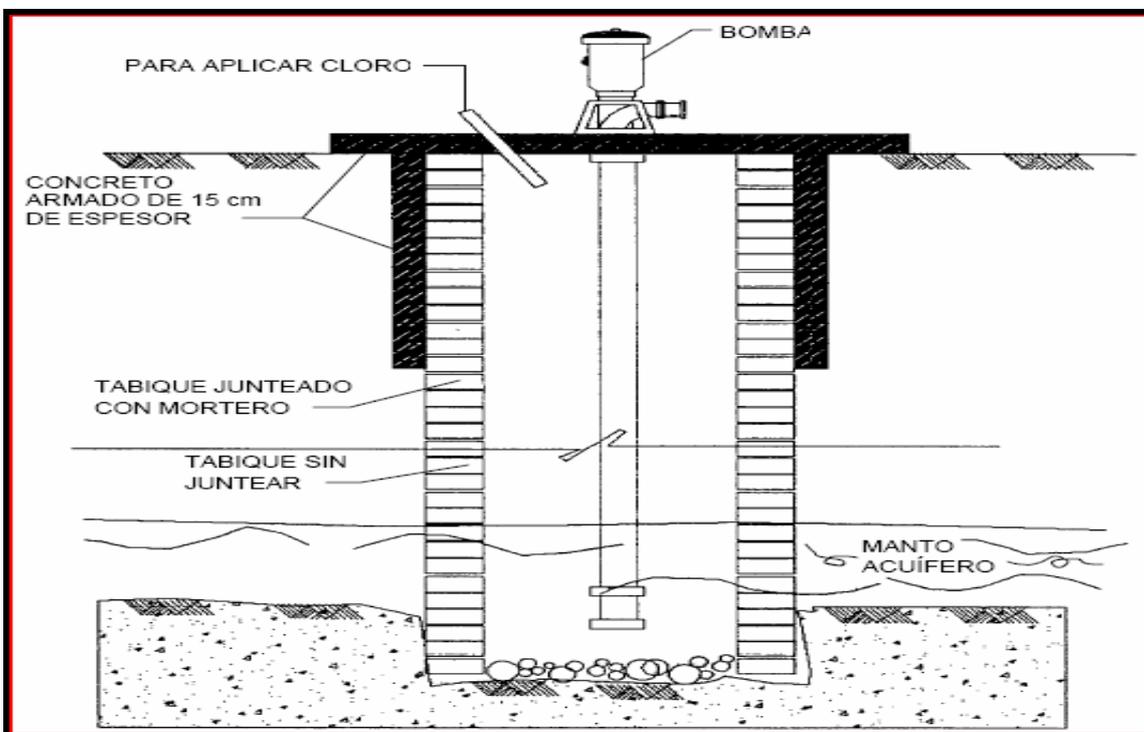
Obra de toma subsuperficial (b)-Pozo con ademe de mampostería
